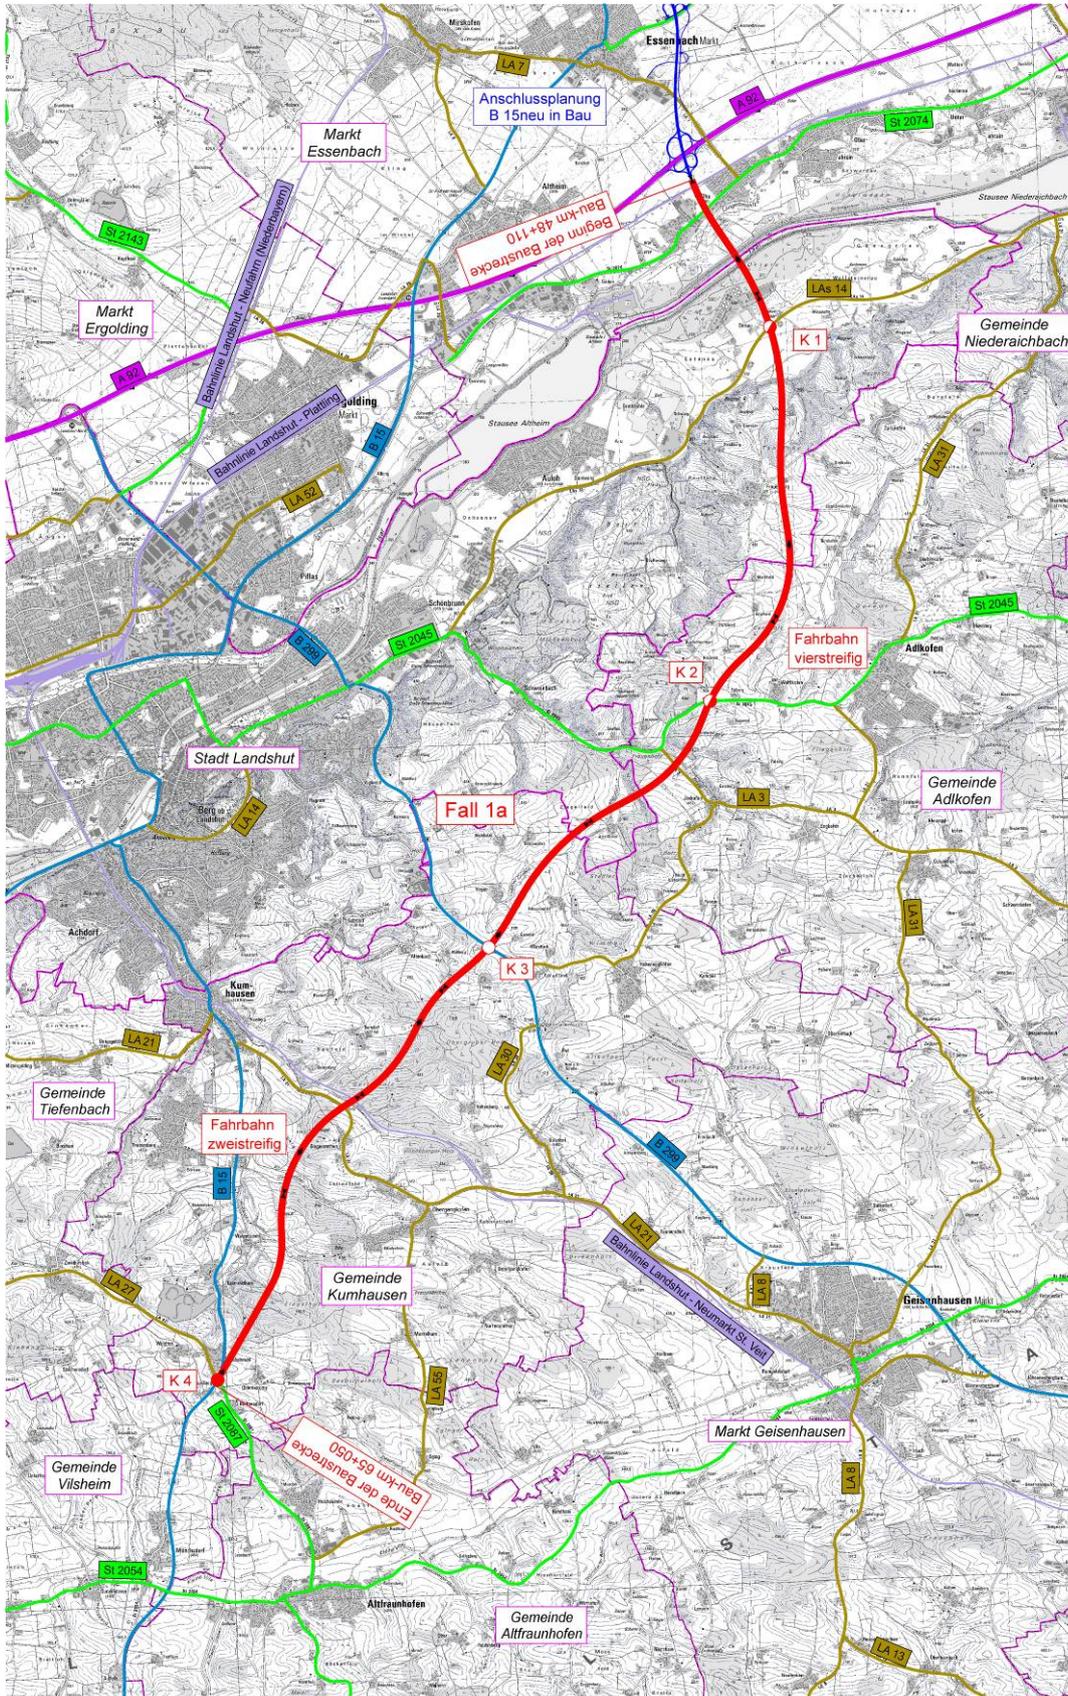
Lageplan Planfall 1a (Unterlage 3, Blatt 2)
